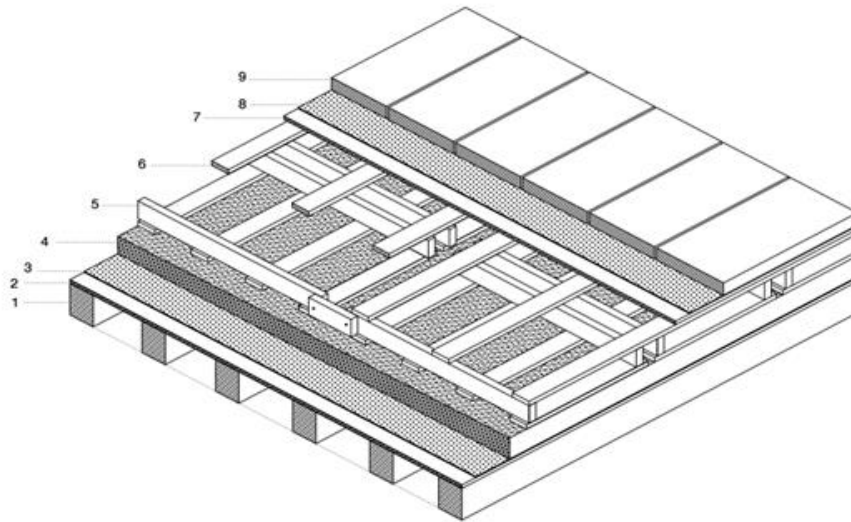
Detalle sección de las capas que componen el sistema constructivo de cubierta.
